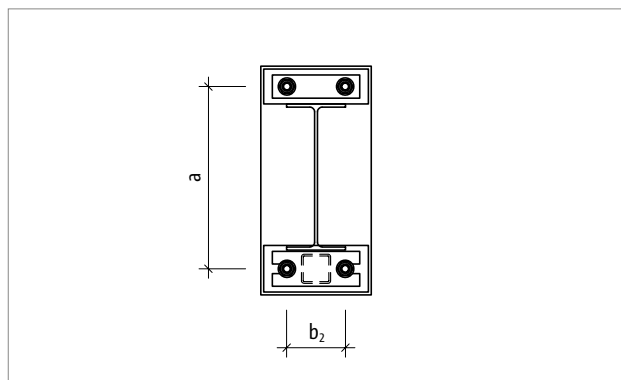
Platine frontale en saillie T type S : calcul des valeurs géométriques d'entrée ; vue de face
